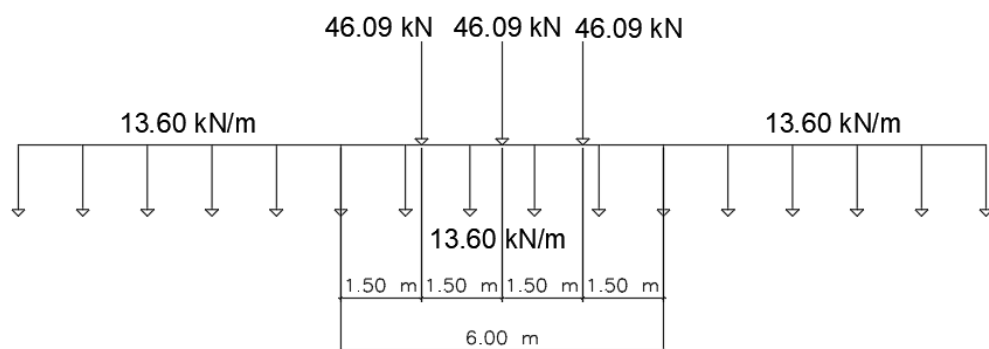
Reação de apoio na Viga Principal 1 (VP1) oriunda da aplicação do carregamento de multidão e passeio.
